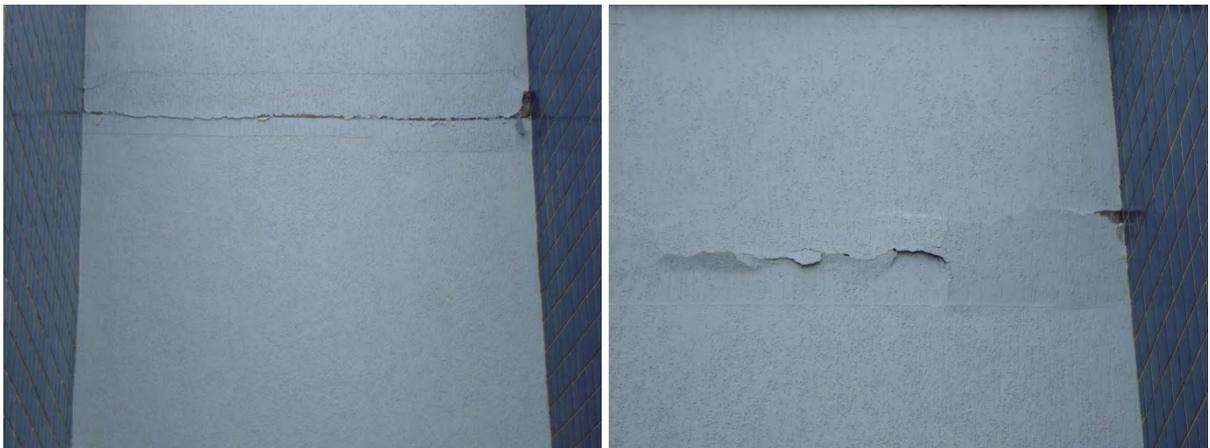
Expansão de argamassa de sobreposição em estrutura metálica secundária.
